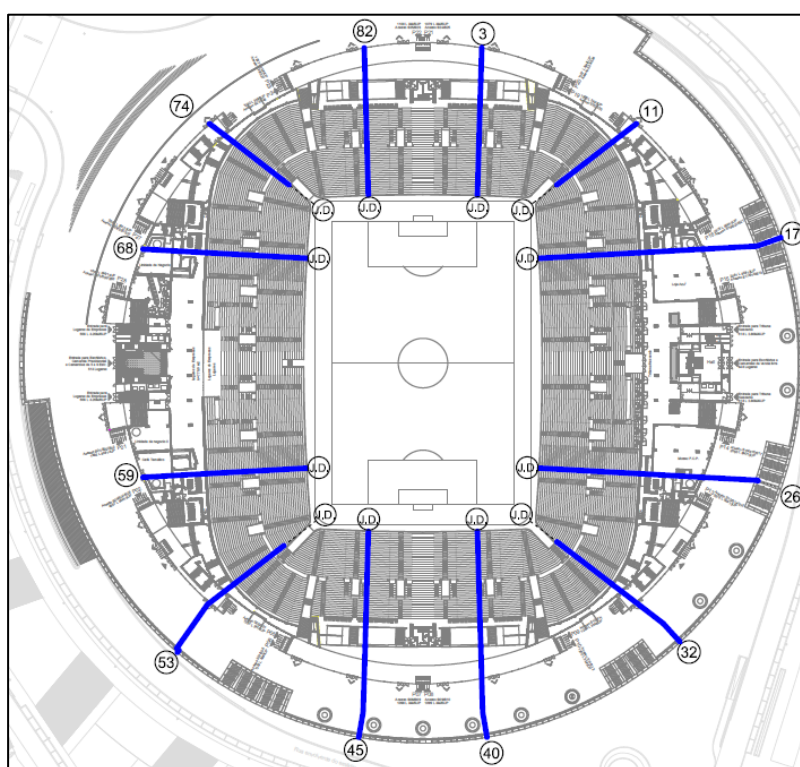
Planta do Piso 0 do Estádio do Dragão. (PortoEstádio)
